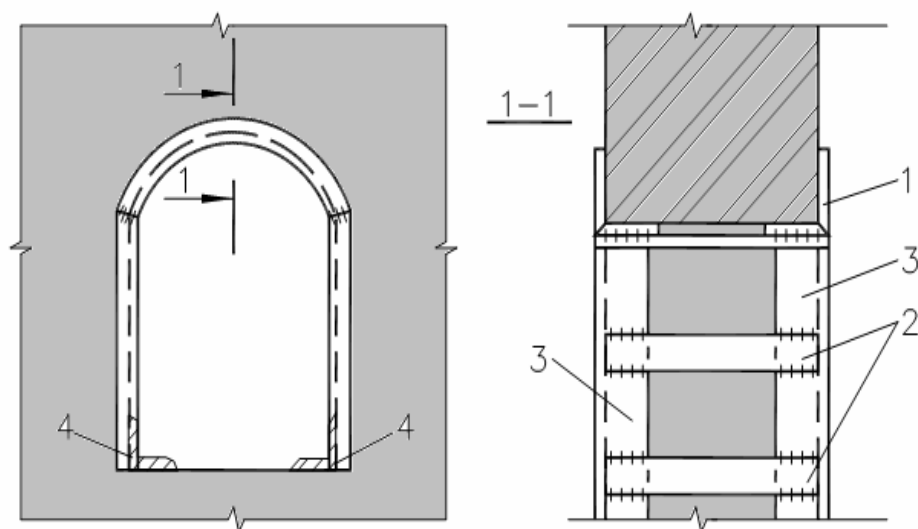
Усиление арочной перемычки: 1 – накладки усиления
